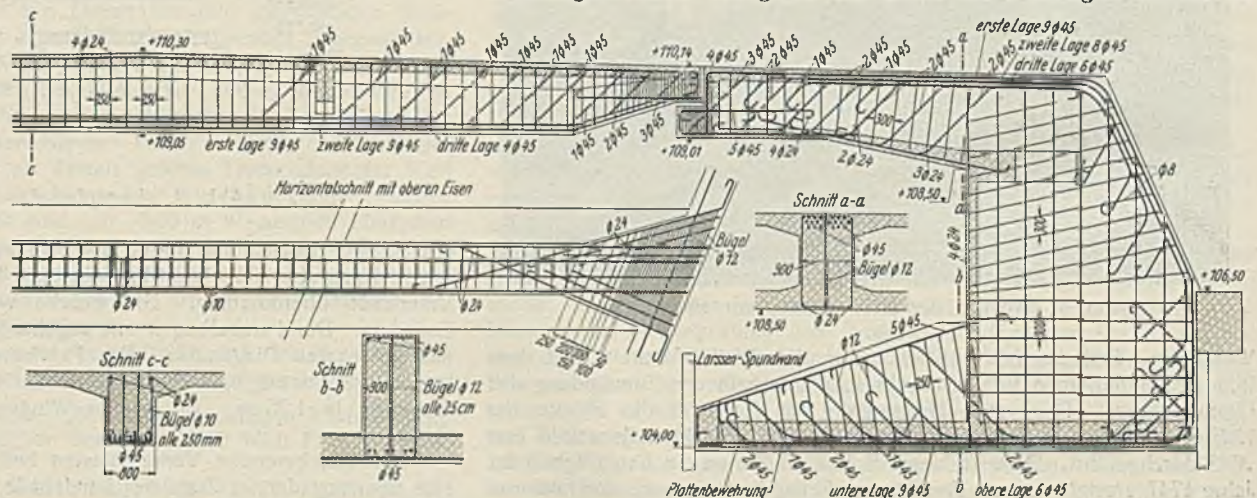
Bewehrungsplan für den mittleren Hauptträger.
